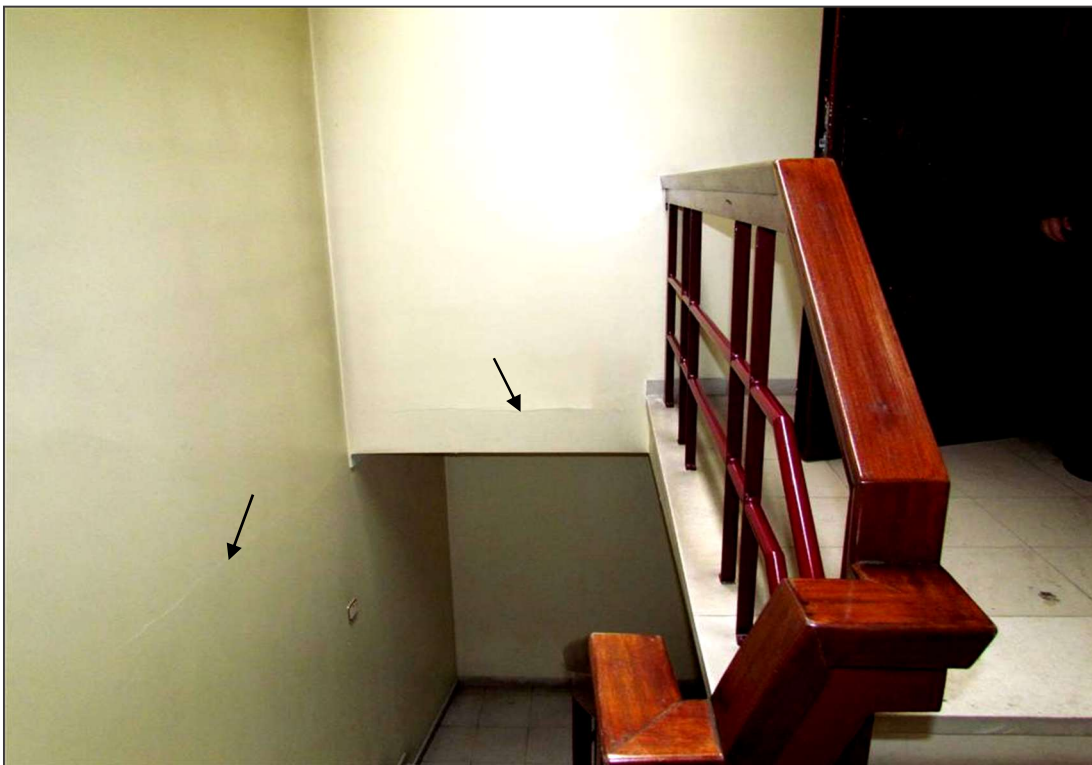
Fissuração horizontal nas paredes da caixa de escadas
